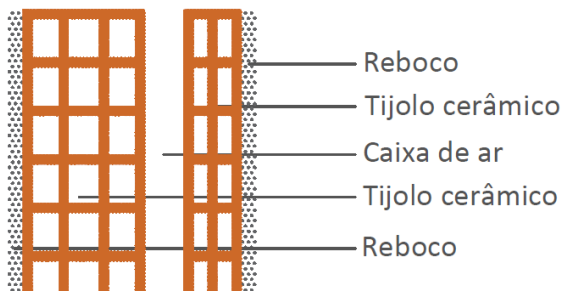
Solução construtiva tipo de parede para caixa de escadas – Pós intervenção
